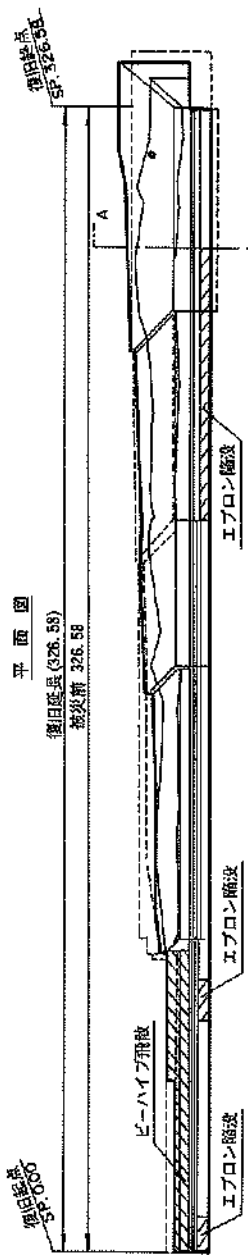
道路被灾位置平面图 (青苗漁港、⑬道路)
